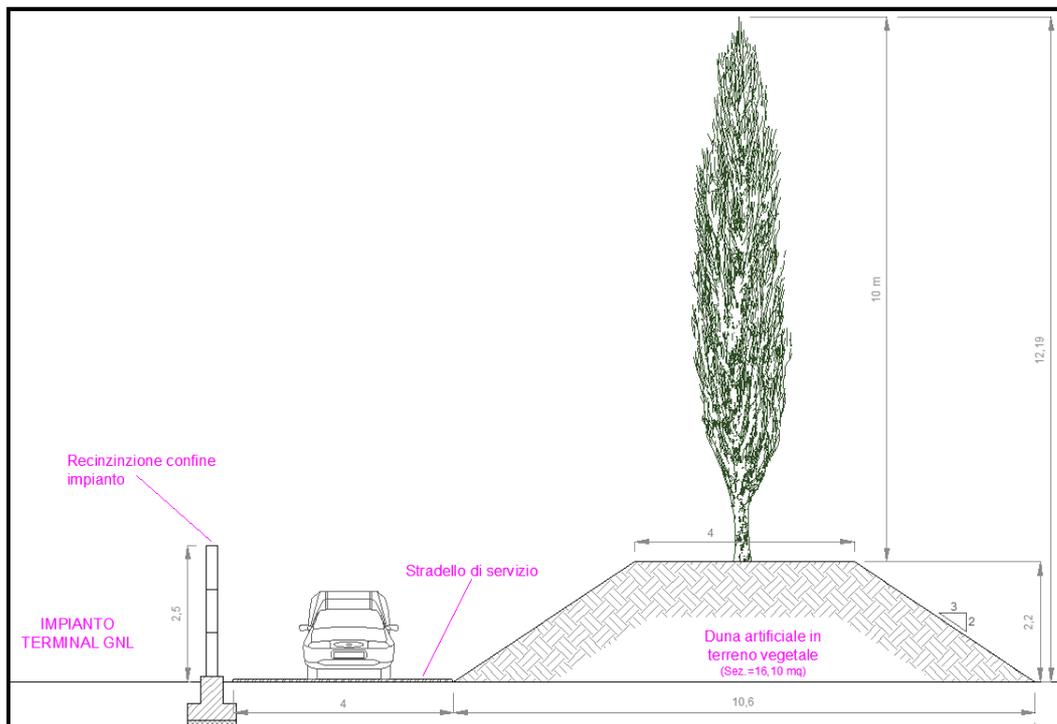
Sezione riportante la barriera visiva prevista su due lati dell'impianto, costituita da rilevato e alberatura.
